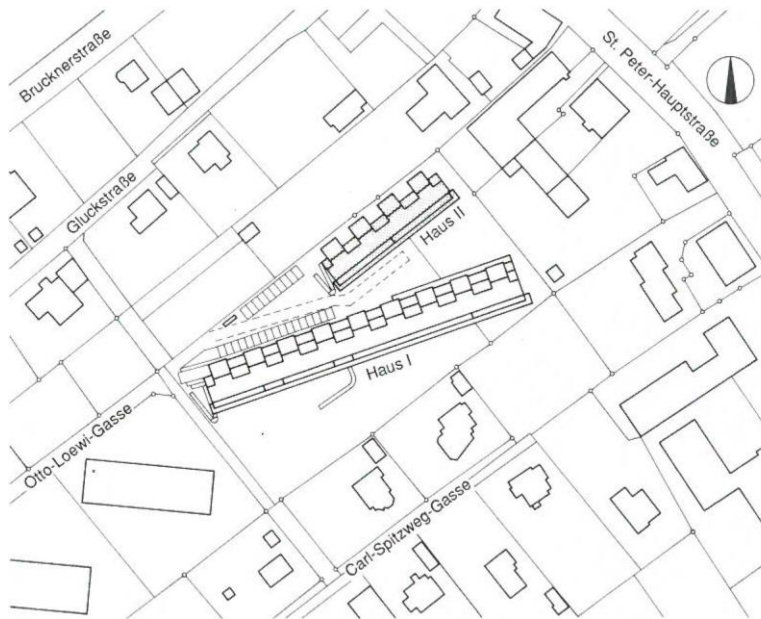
Lageplan Carl-Spitzweg-Gasse, o.M.
